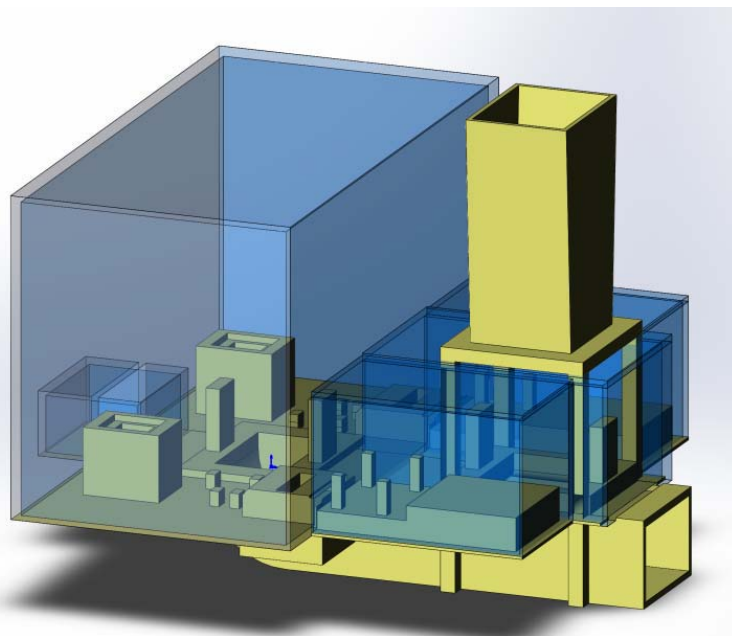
Фундаменты компактной вентиляторной установки с вентиляторами ВО-42,5РЗ
